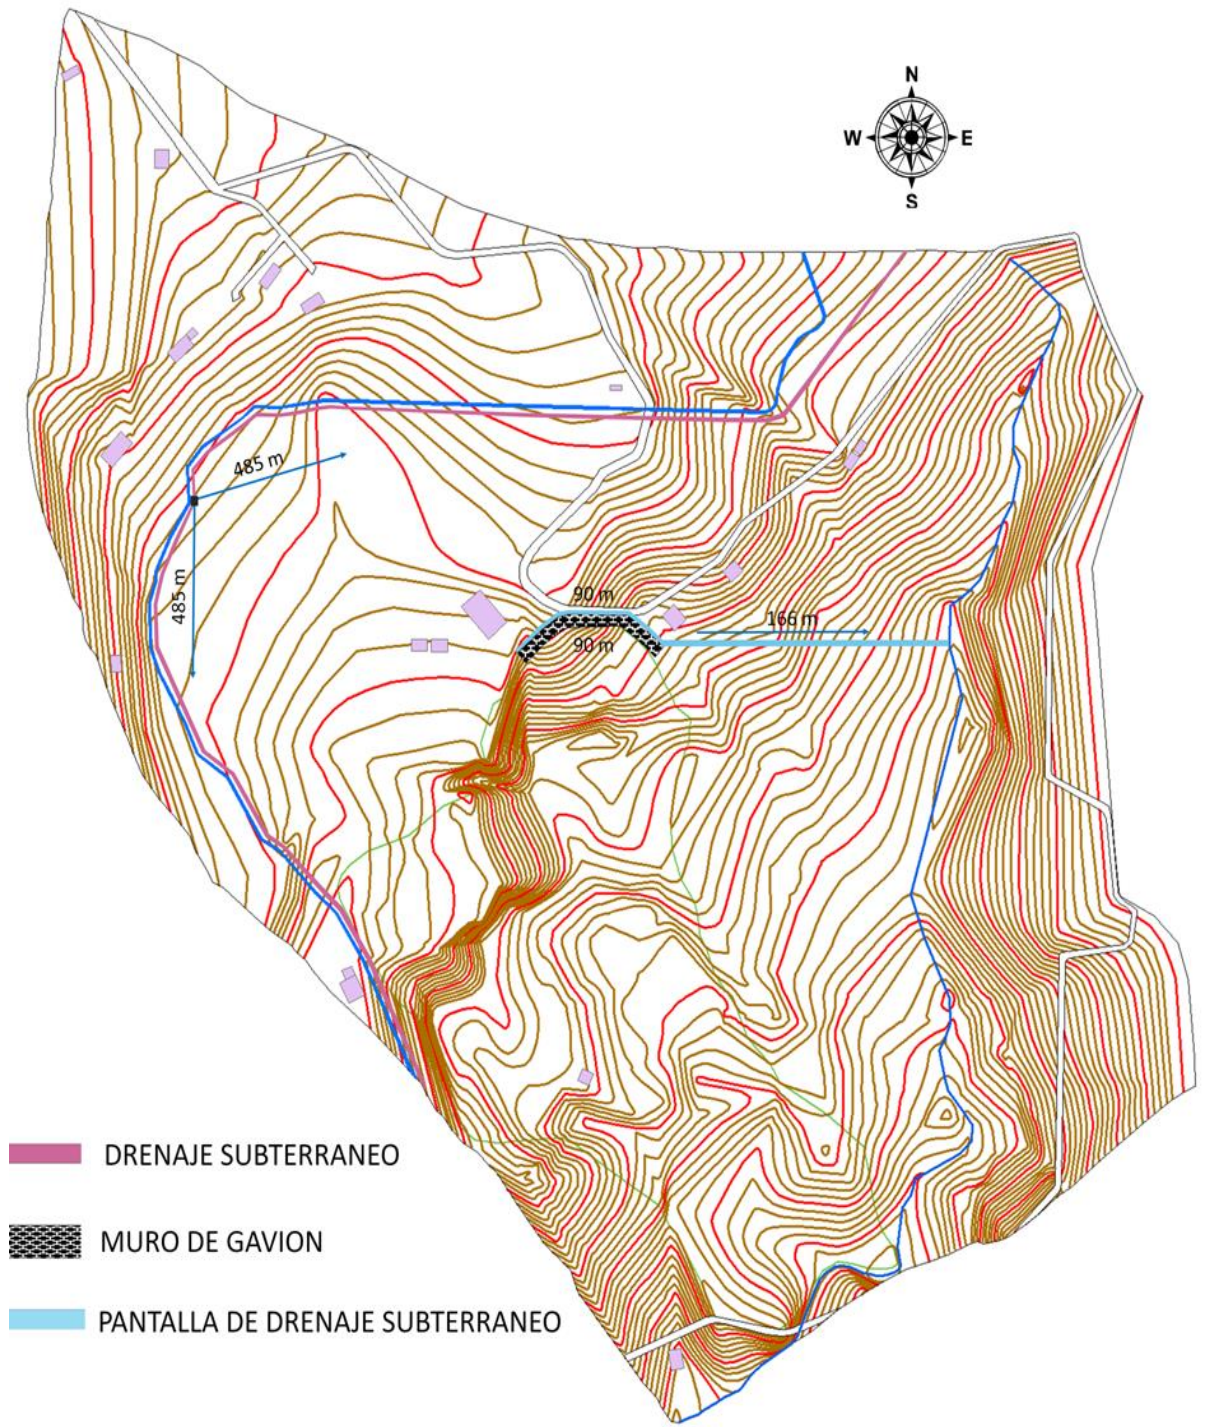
Distribución del drenaje, muro de gavión, pantalla de drenaje subterráneo en el sector de estudio
